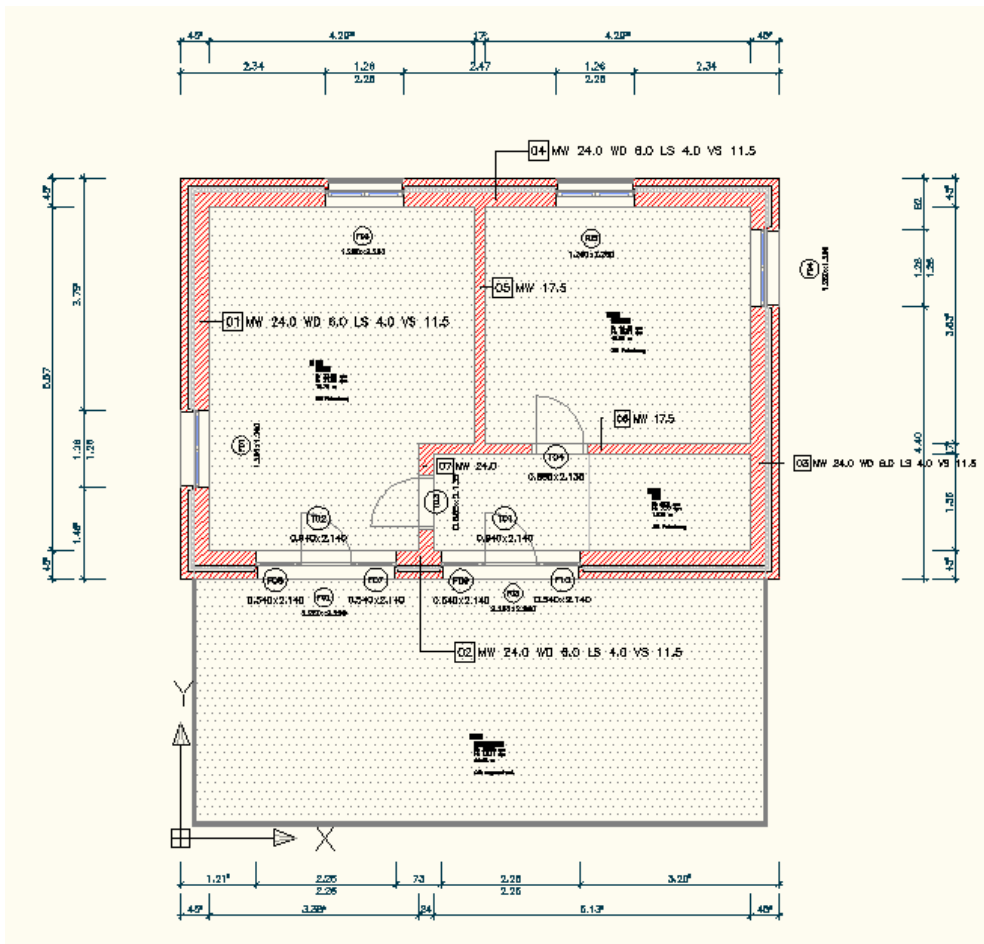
Beispielprojekt - Grundriss Dachgeschoss
